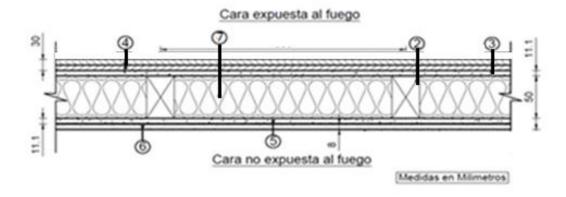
Vista en corte solución propuesta (a asimilar) – Tabique perimetral 16
